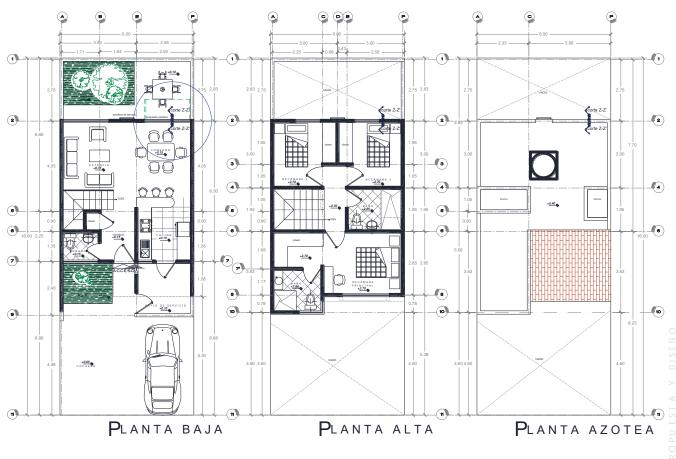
Ubicación propuesta partesol Vista en planta prototipo 3REC.
